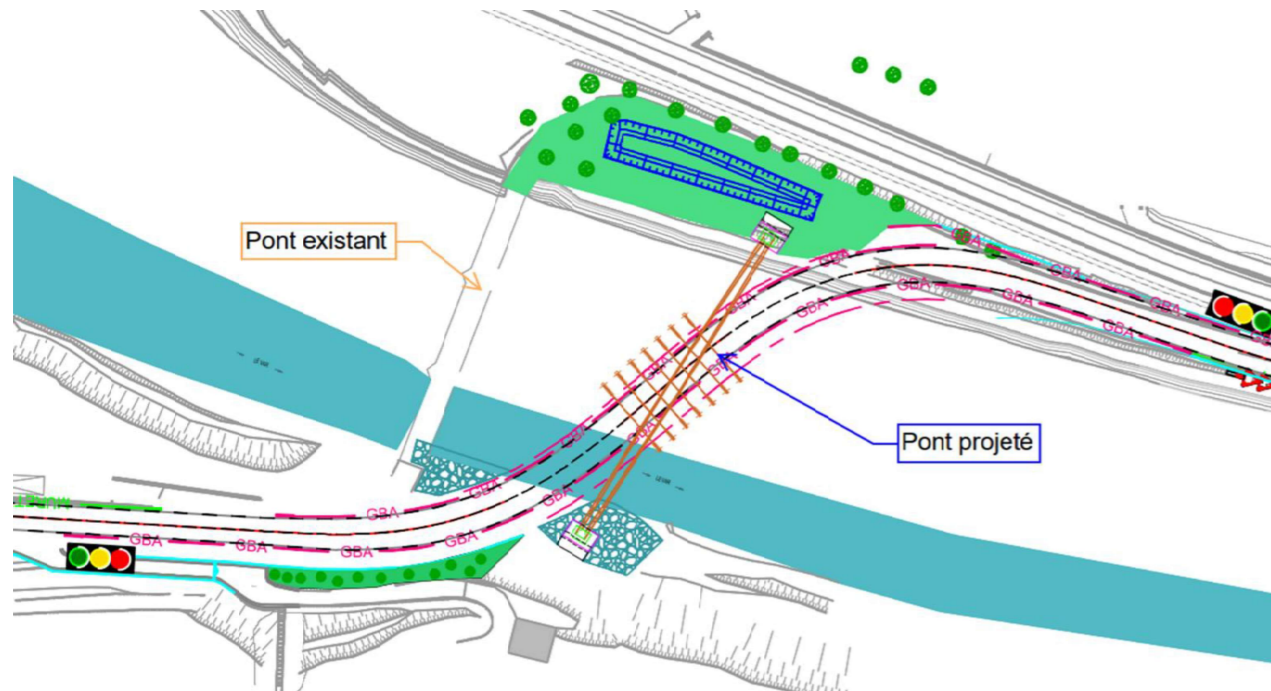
Ouvrage projeté – vue en plan (dossier PRO)
